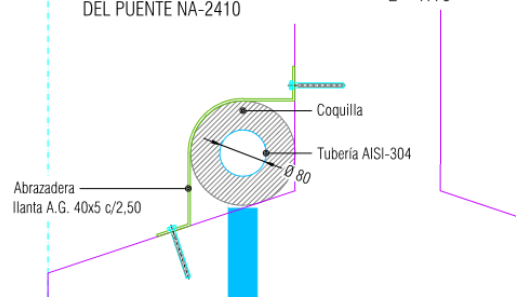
Detalle paso ramal PE90 anclado a vigas A-15 / N-2410
